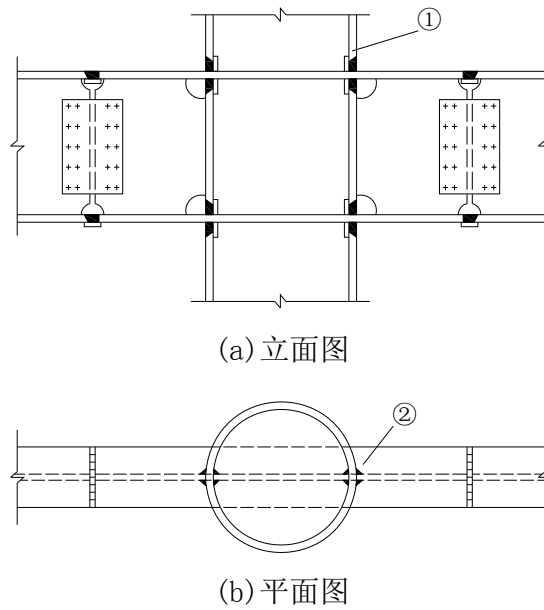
钢梁 - 钢管混凝土柱穿心式连接
